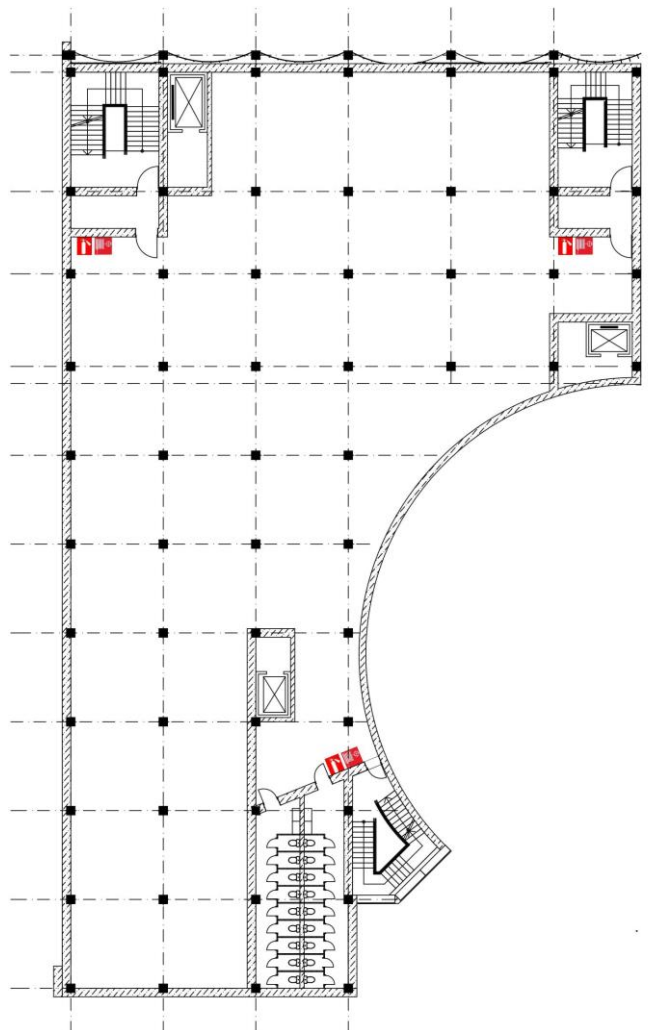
План укриття у підвальному приміщенні громадського центру
